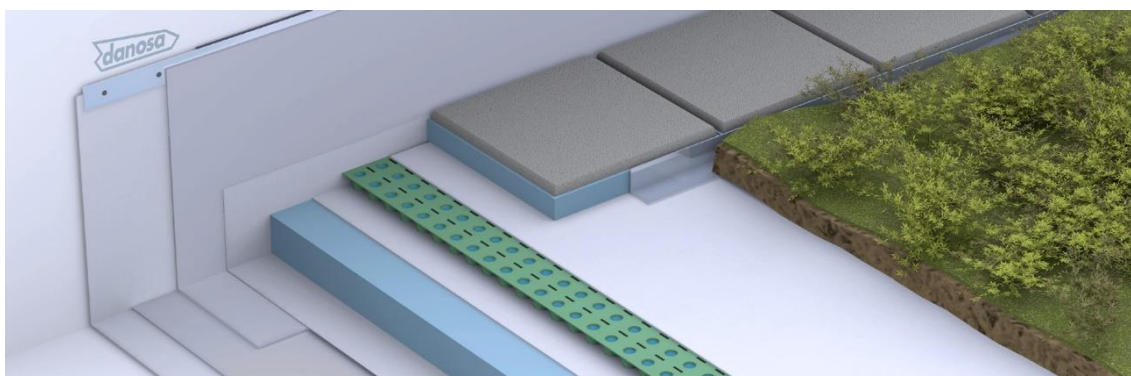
Cubierta plana ajardinada extensiva con PVC.
